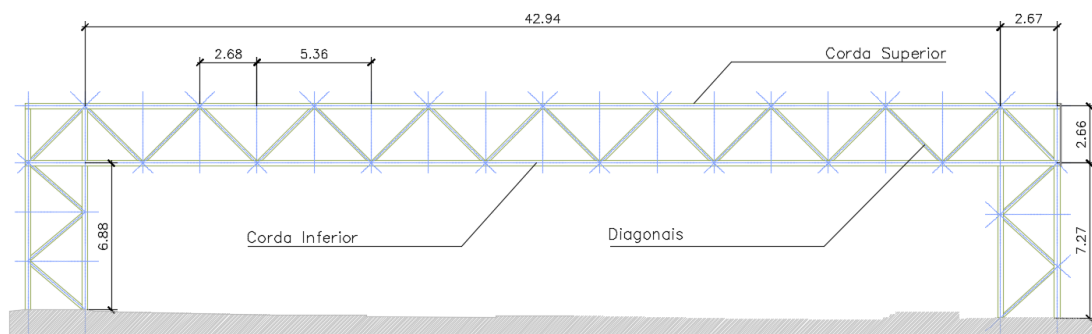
Treliça do passadiço tipo “Warren Truss”.
